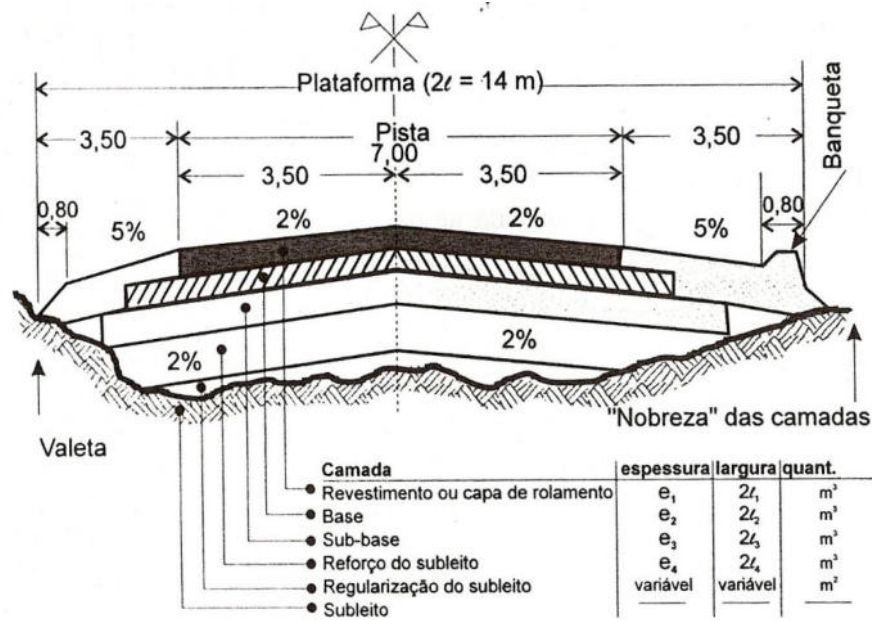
Desenho esquemático da seção transversal das camadas do pavimento - (Fonte: Senço, 2007)
